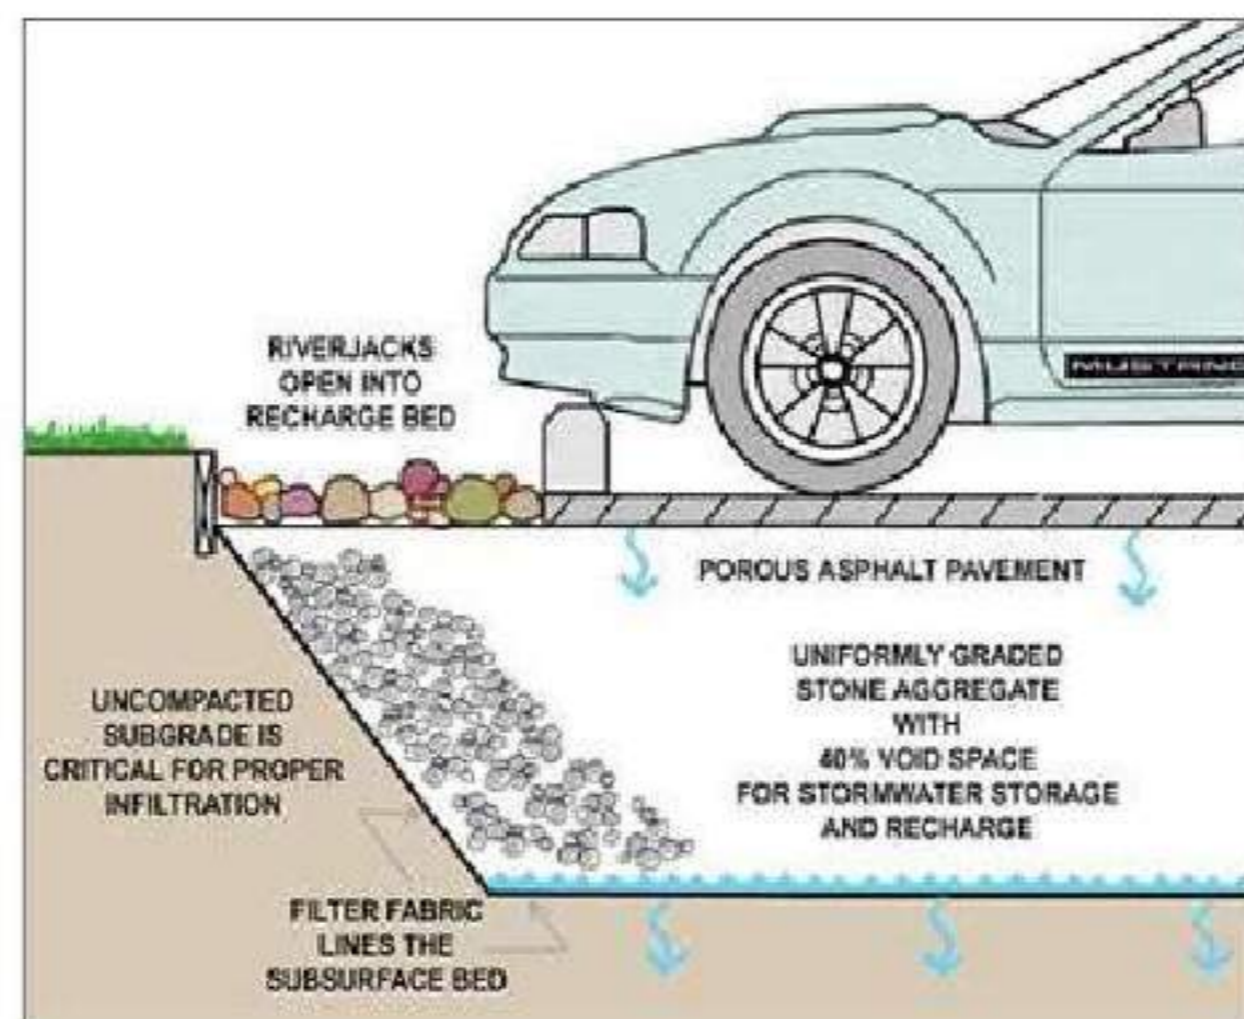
Funzionamento di un parcheggio con pavimentazione porosa [Pennsylvania Stormwater Management Manual]
